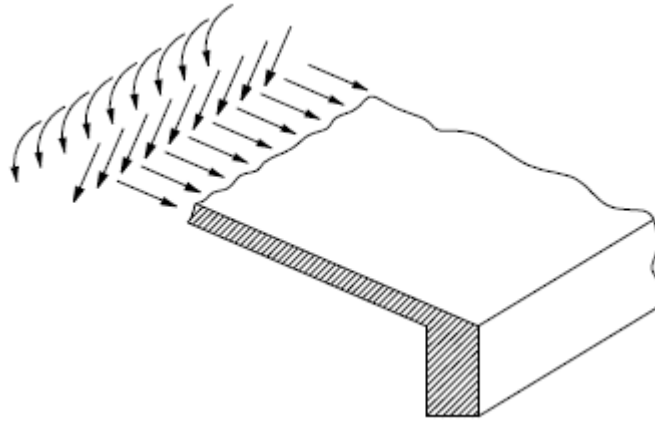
Apoio de uma laje inclinada numa viga de extremidade [4]
